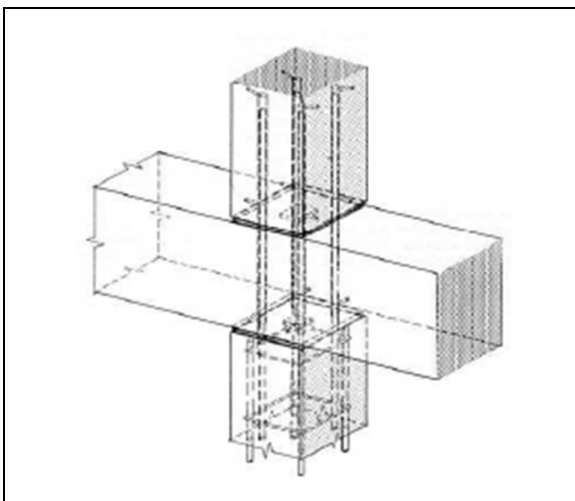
Interrupção de pilar com ligação por armaduras (Stupré, 1981)
